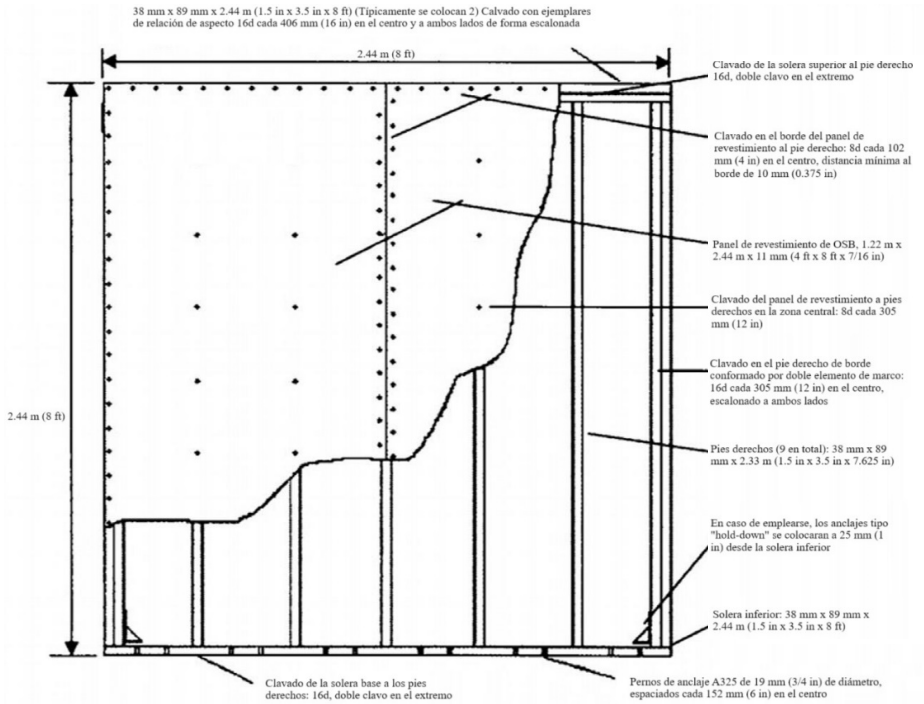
Geometría típica del muro de corte con entramado ligero de madera, tomada de Lebeda et al. [6]
